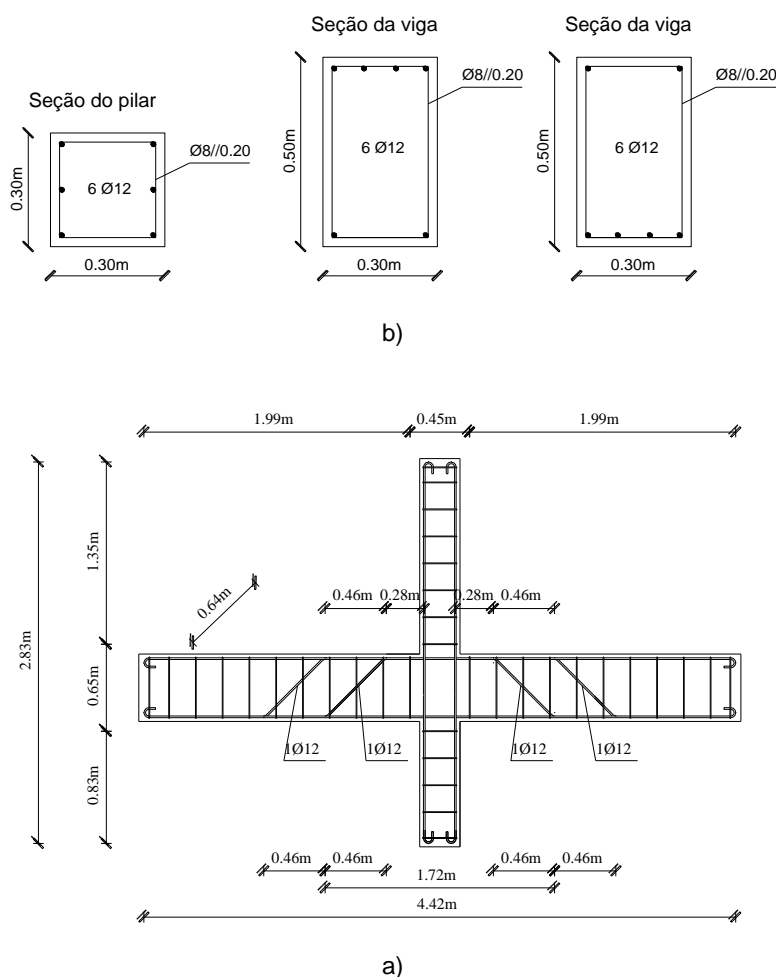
Armadura do provete IPE; a) em planta; b) em corte.
